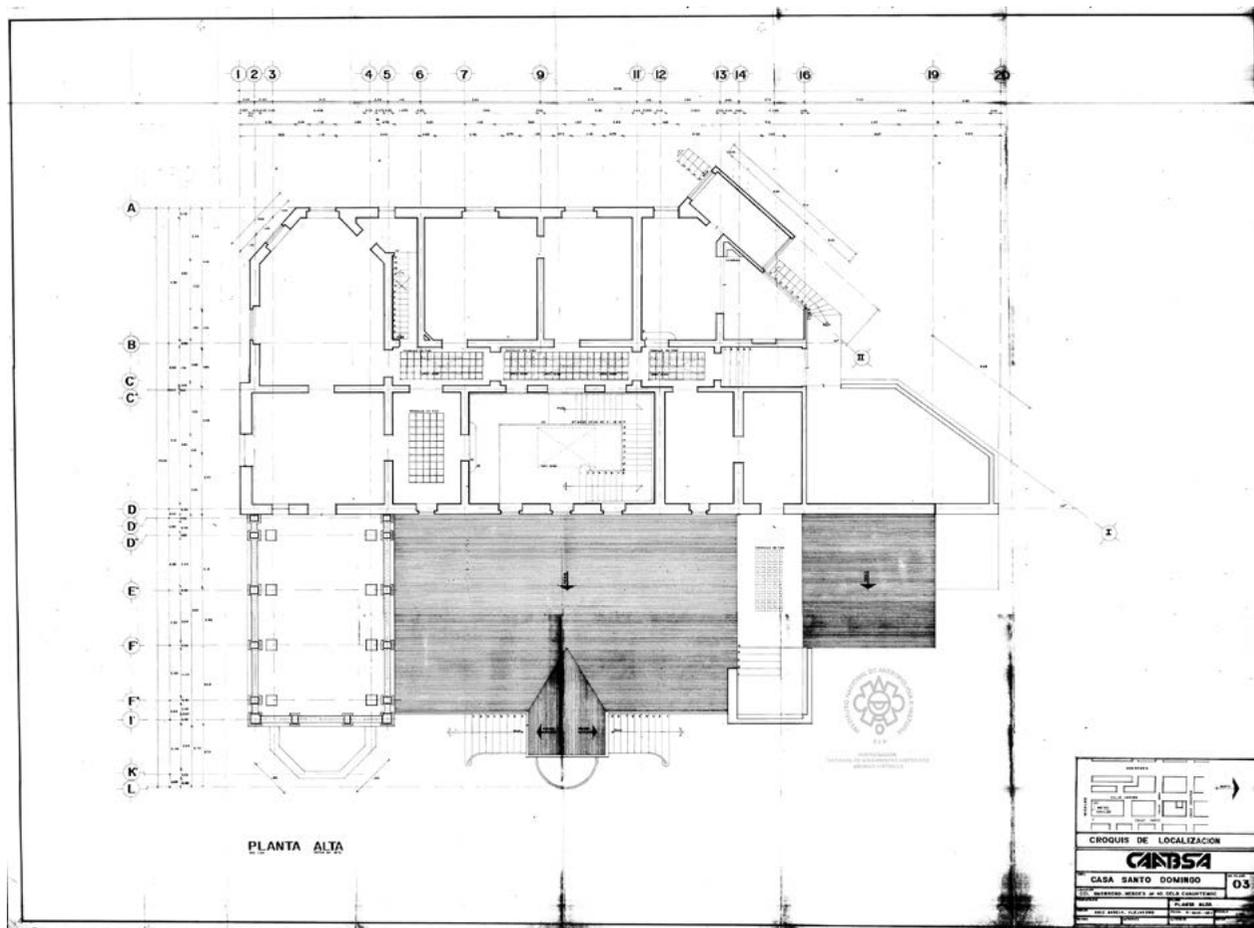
Plano de la casa de Antonio Rivas Mercado, planta alta. Fuente: AHJECNMHINAH.
